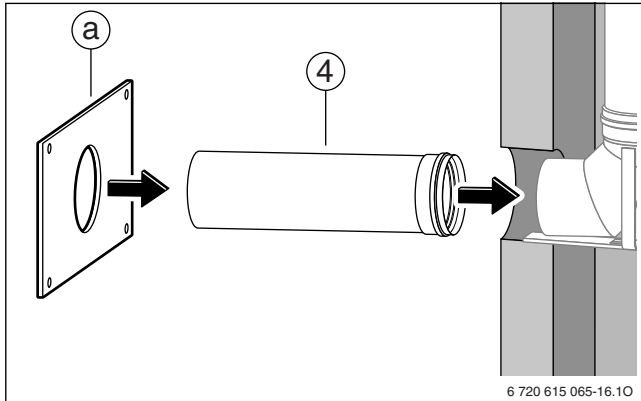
Montage der Sammelrohr-Verlängerung am Beispiel Schacht
